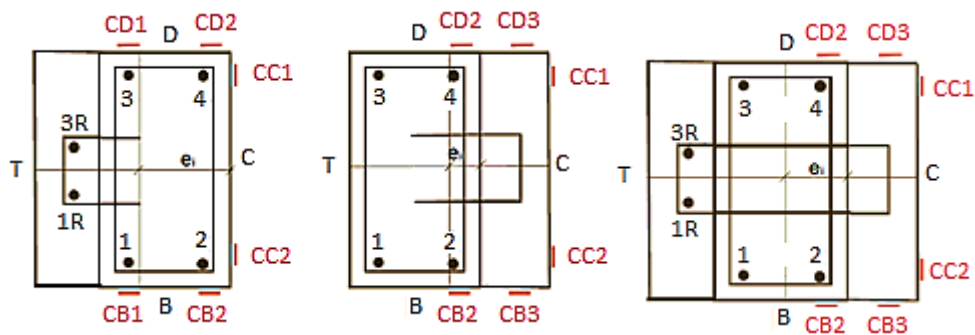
30 - Posicionamento dos extensômetros no concreto (OMAR, 2006)
